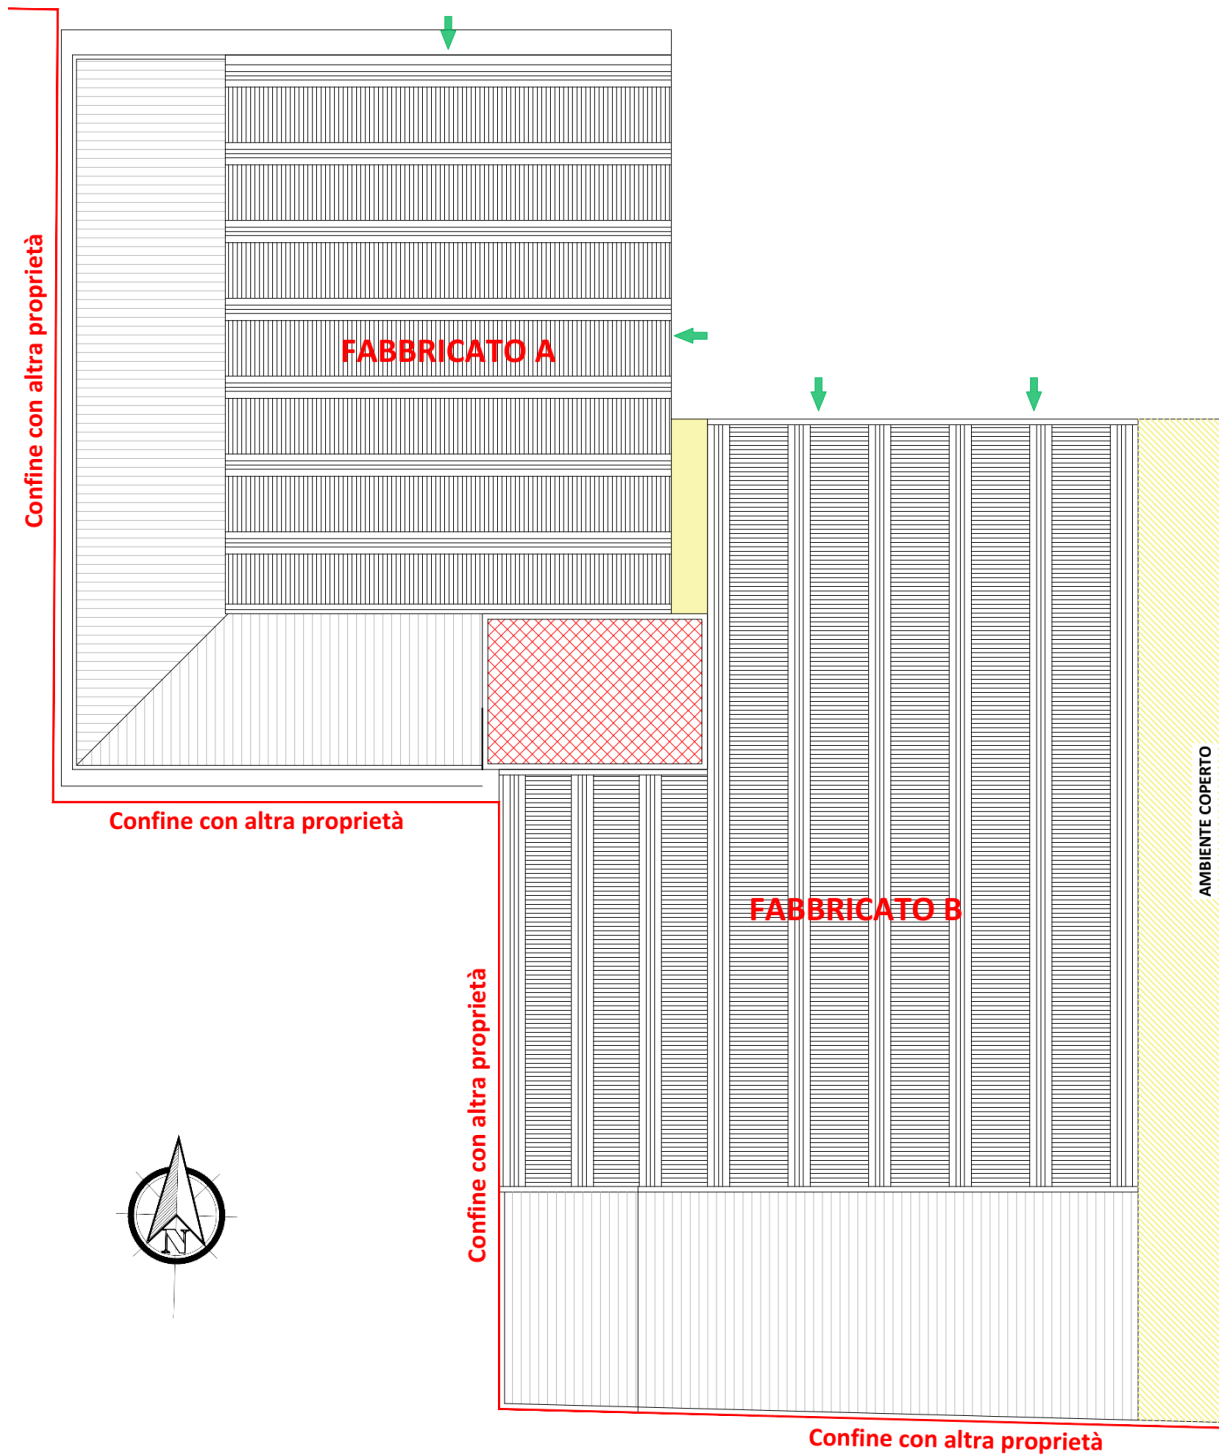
Planimetria dei fabbricati oggetto di stima - PIANTA PIANO PRIMO (Quota +4,00 m)
